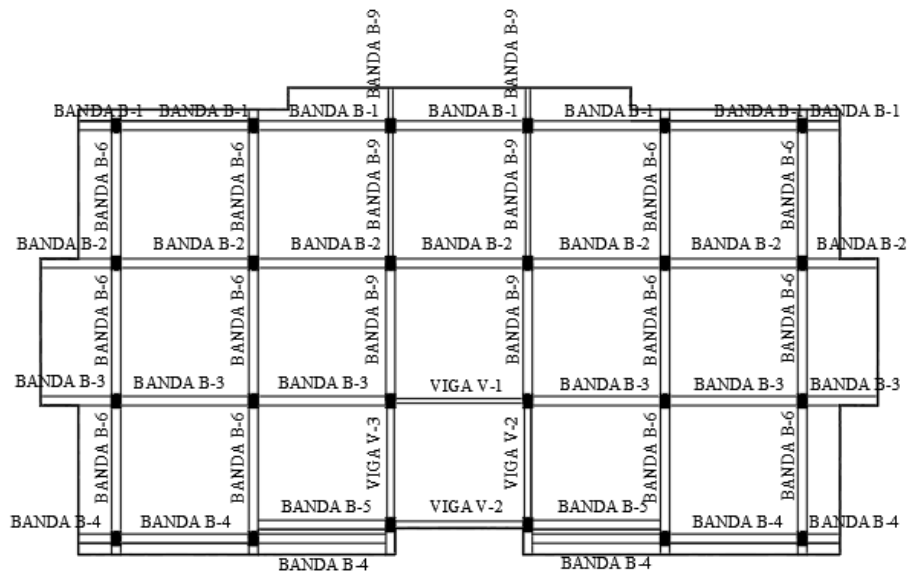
Detalle de ubicación de vigas y vigas banda en nivel 4
